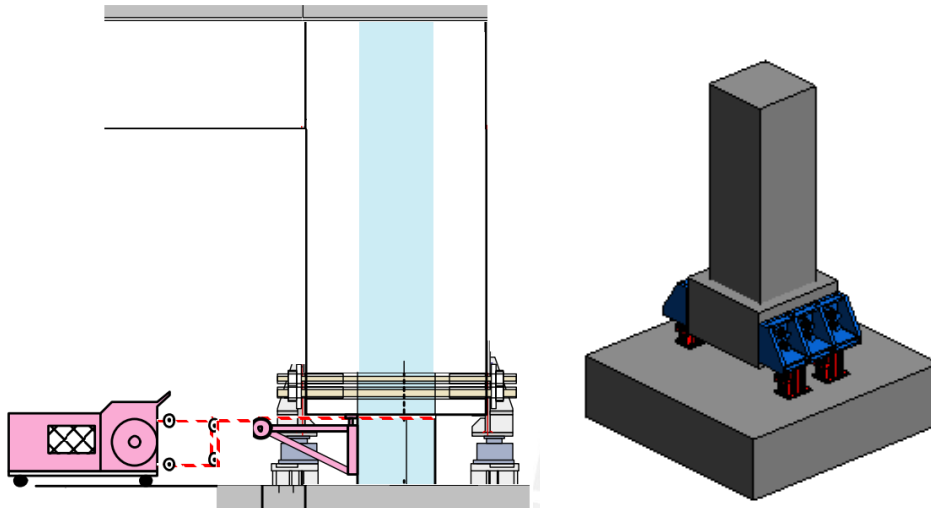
a) Corte de columna (Masuzawa, 2004- Modificado); b) Columna luego del corte (HERM-Revit)
